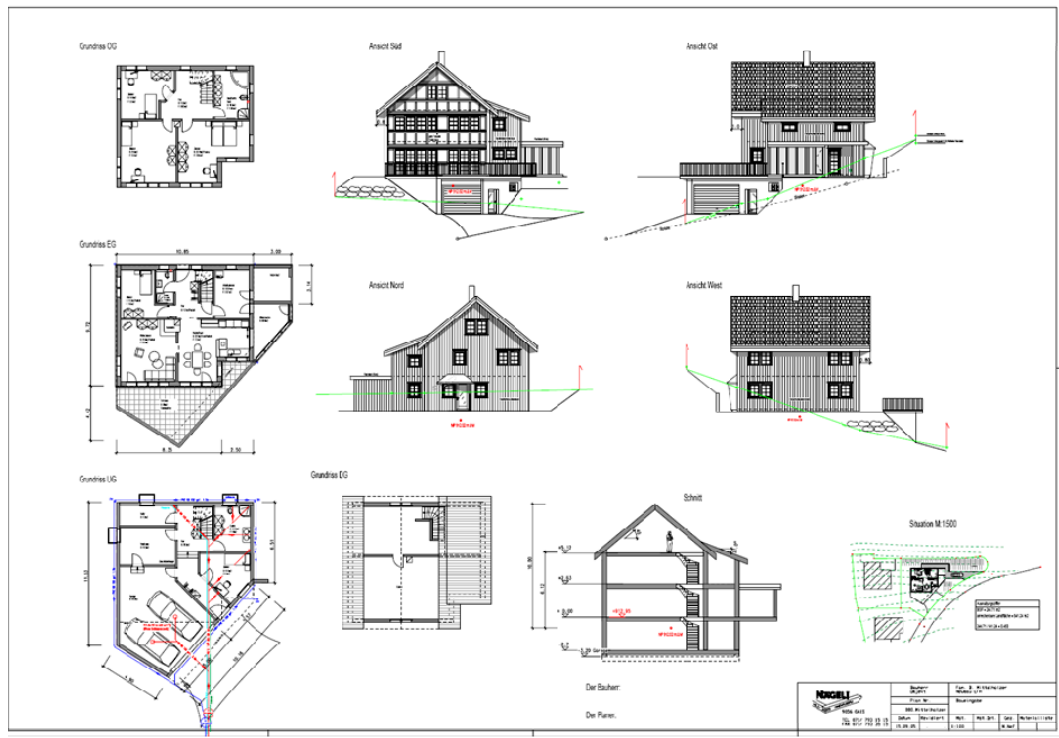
Plangrundlagen des Hauses Bruno Mittelholzer in Gonten
